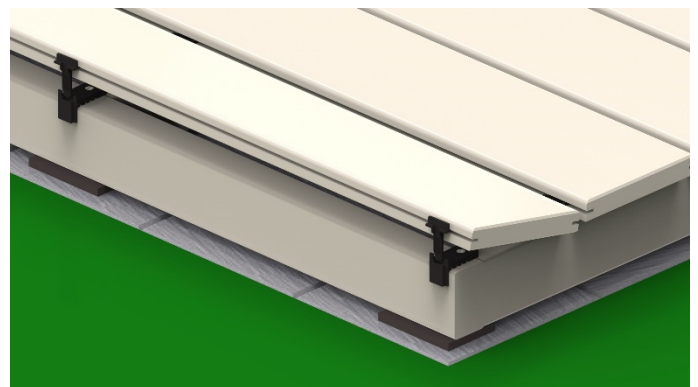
Die Diele wird danach schräg auf den RASK-Clip geschoben und anschließend können die Oberteile in die Nut der Diele gesteckt werden.
